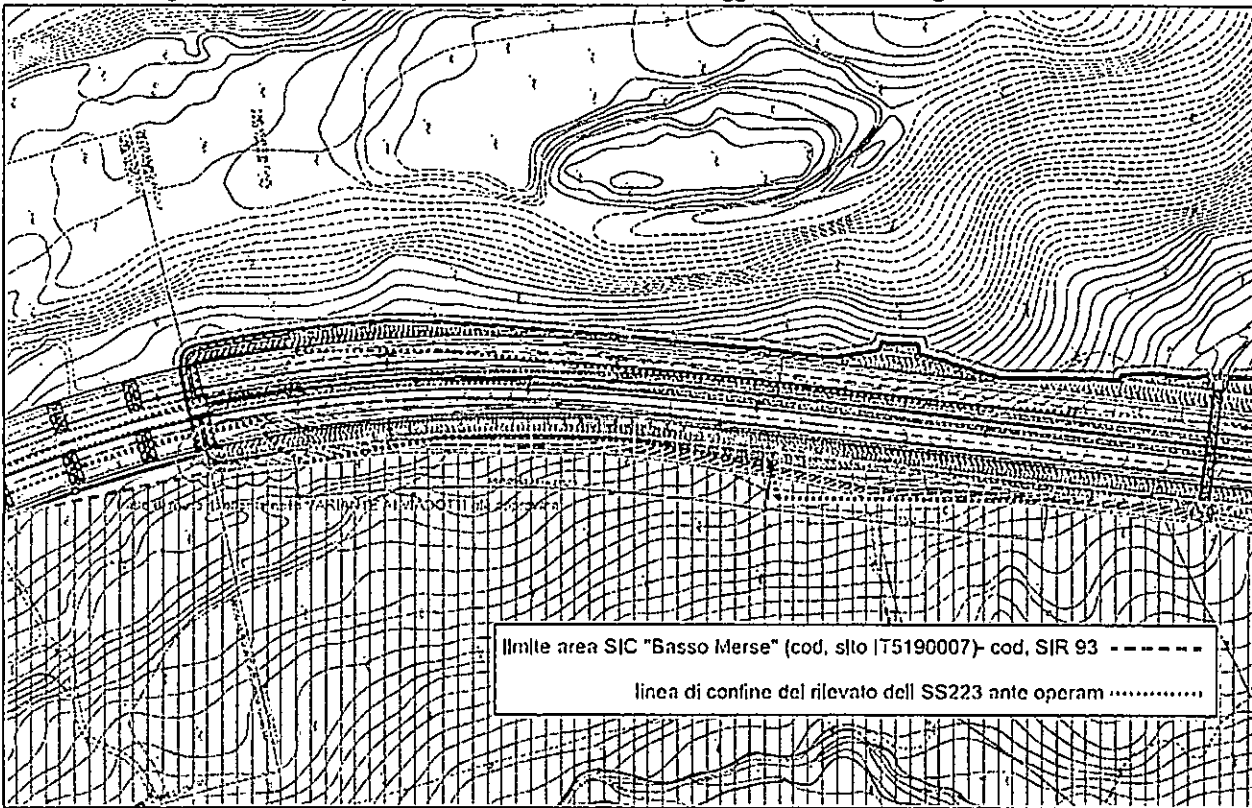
Sistemazione carreggiata destra - Proposta di variante muro MU24
